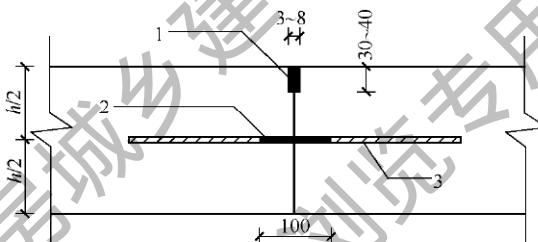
纵向施工缝构造（尺寸单位：mm）
